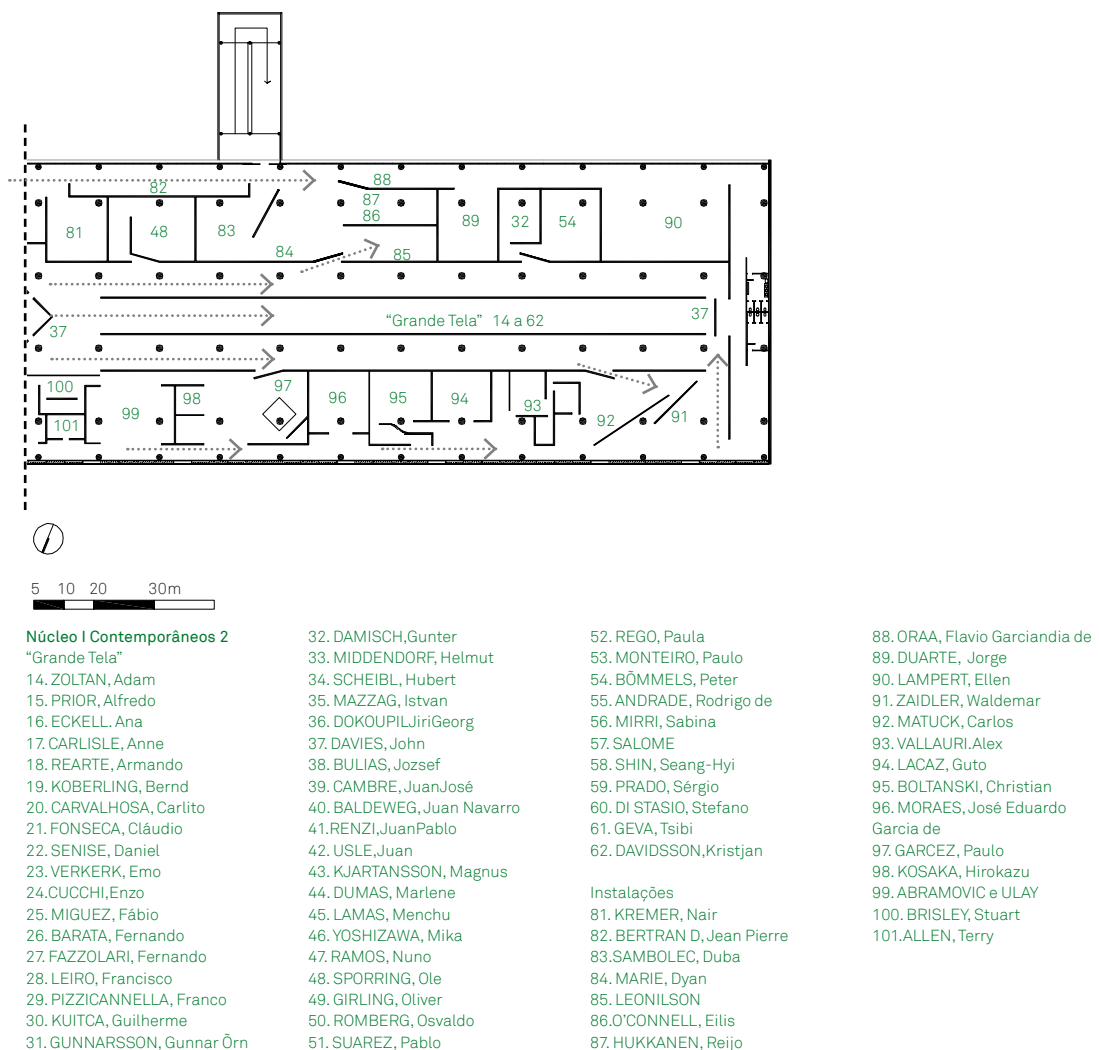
Segundo trecho PLANTA DO SEGUNDO PAVIMENTO
